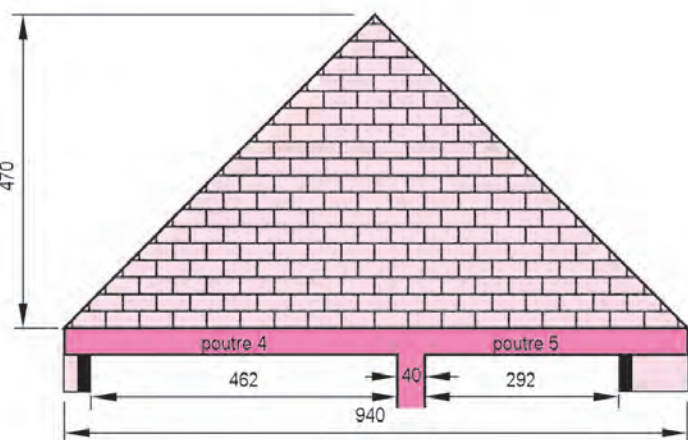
Schéma du cas de chargement des poutres n° 4 et n° 5
